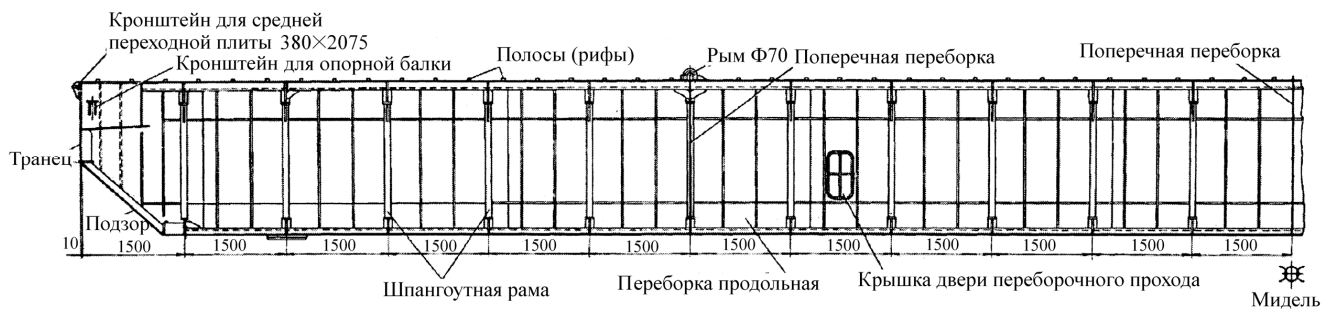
Продольный разрез корпуса стального понтона плавучего причала
